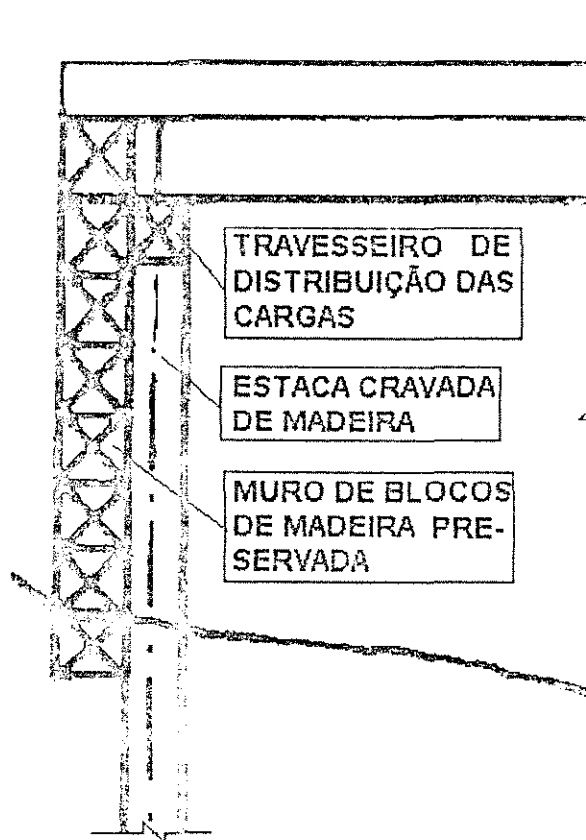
Fundação em estaca com muro de contenção em madeira preservada.
